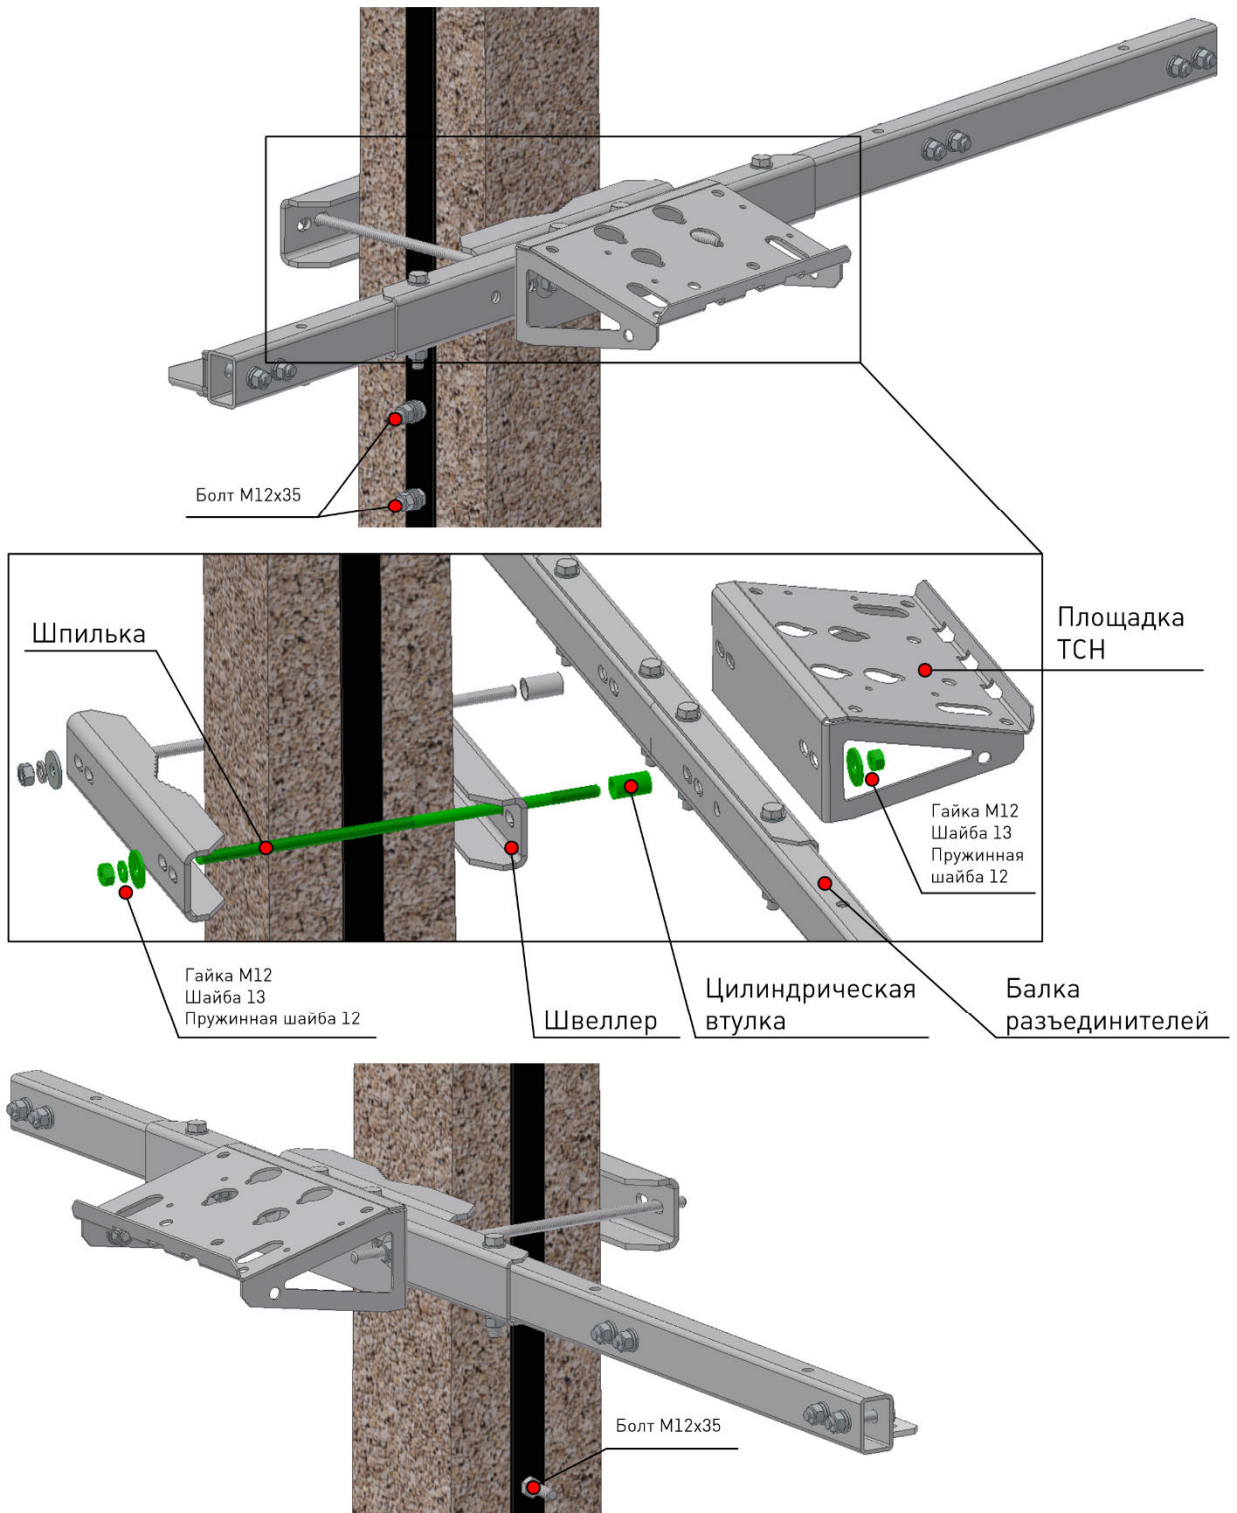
Монтаж балки разъединителей и площадки TSN
